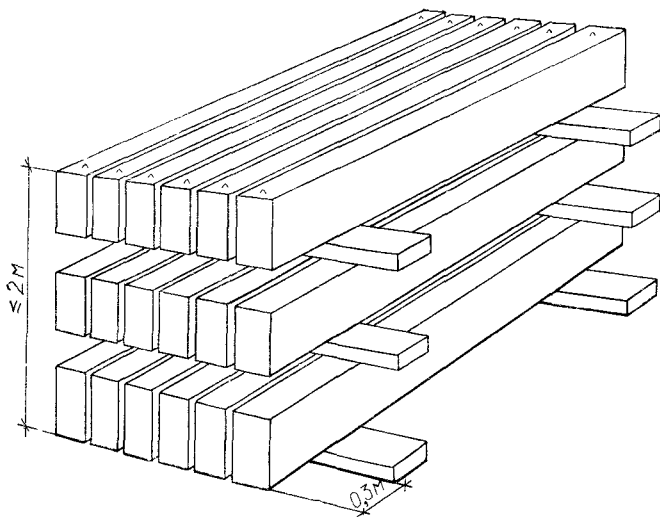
Ригели, балки, прогоны, колонны укладывают в штабель высотой не более 2 м на подкладках и прокладках.
